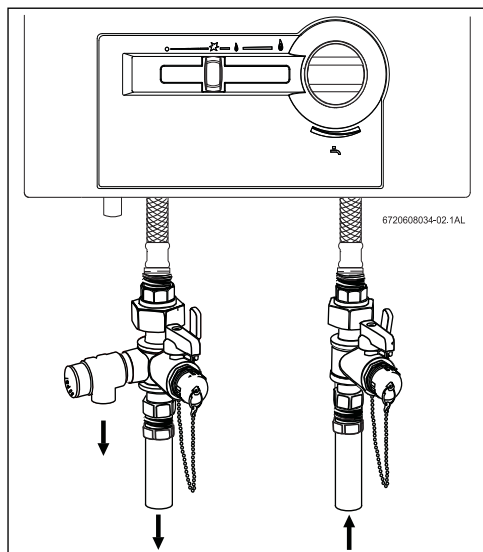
Raccordement des conduites et de la soupape de sûreté
